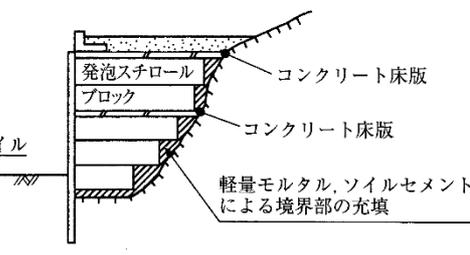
岩盤斜面へのすり付け方法の例⁸⁾
